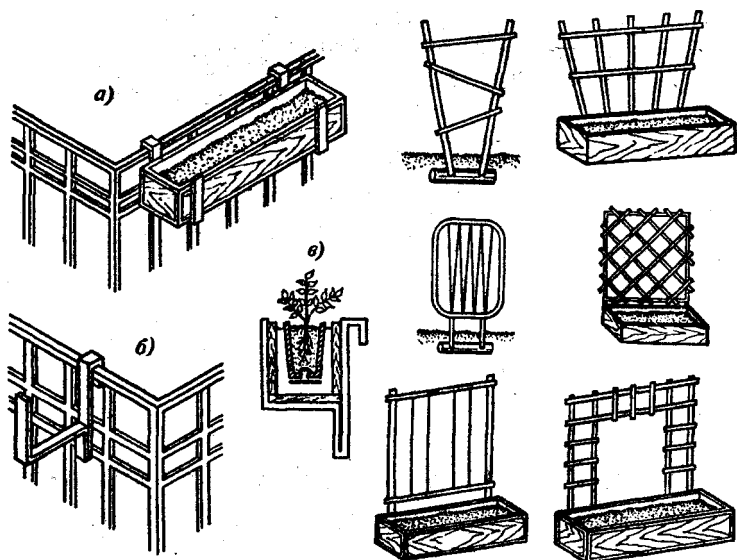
Установка и укрепление ящиков на балконах с решетчатым оформлением:
